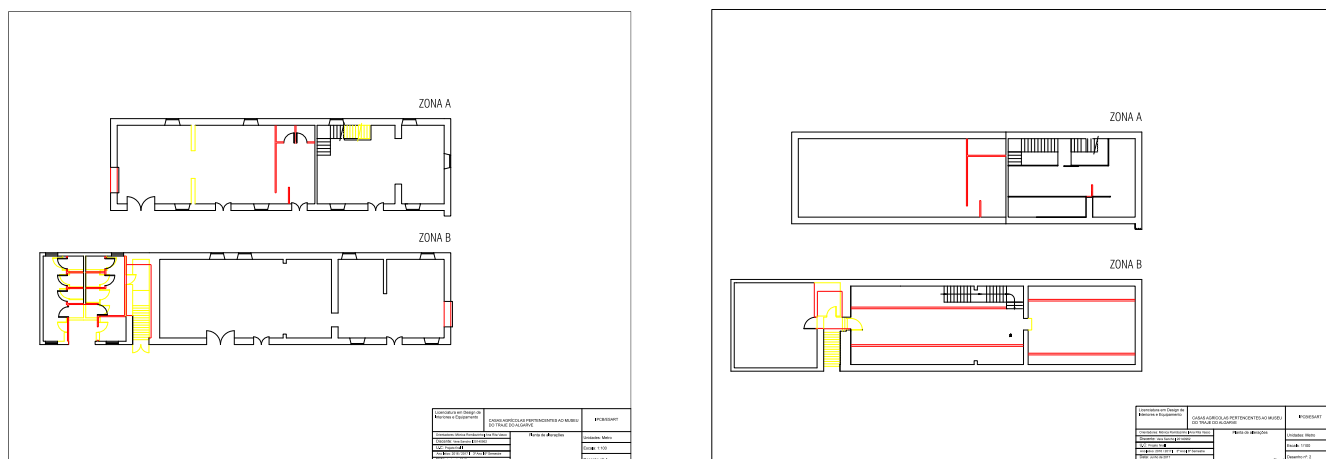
Planta de Alterações Piso 0 e Piso 1 respetivamente da esquerda para a direita. Elaborado por: Vera Sancho
